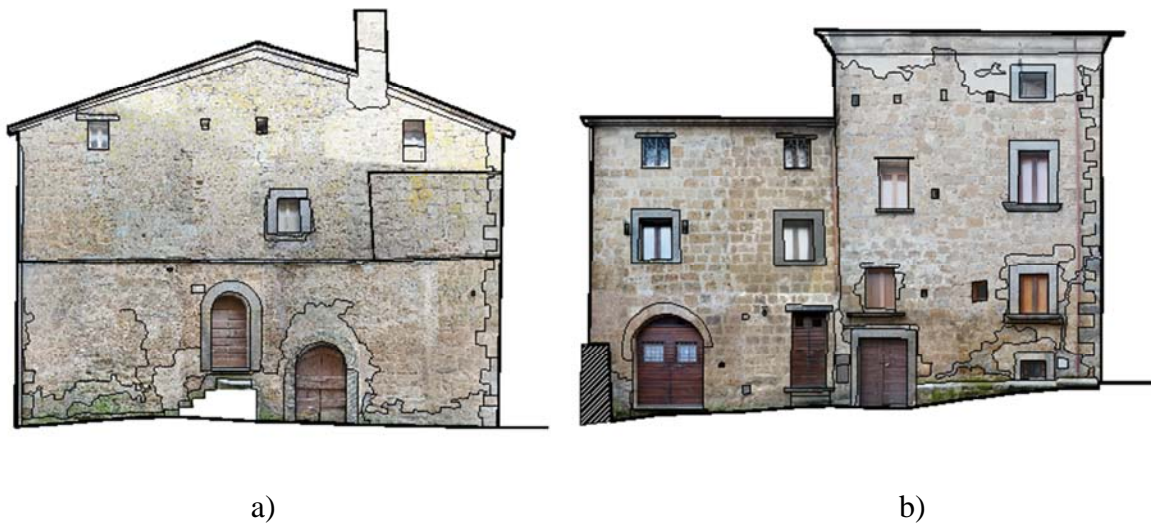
a) Prospetto Ovest, b) Prospetto Est 1:200
